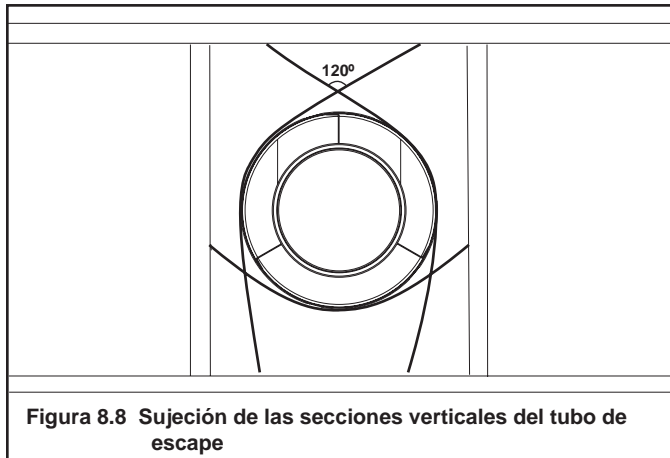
Sujeción de las secciones verticales del tubo de escape
